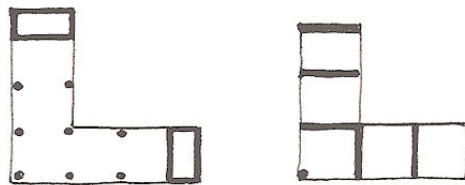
Ailes de bâtiment raidies transversalement. Les déformations différentielles peuvent rester faibles.
